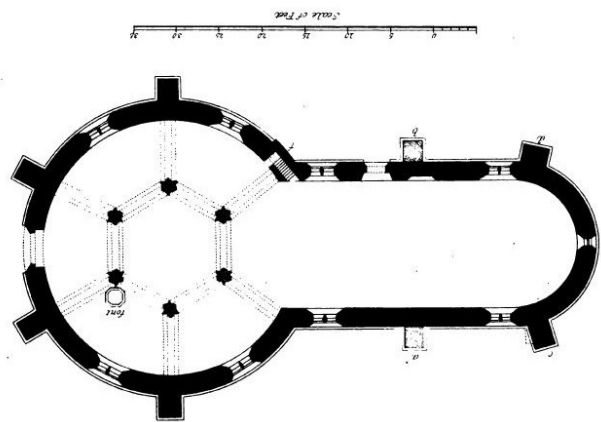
Grundriss, St. John, Little Maplestead, 13./14. Jh.
